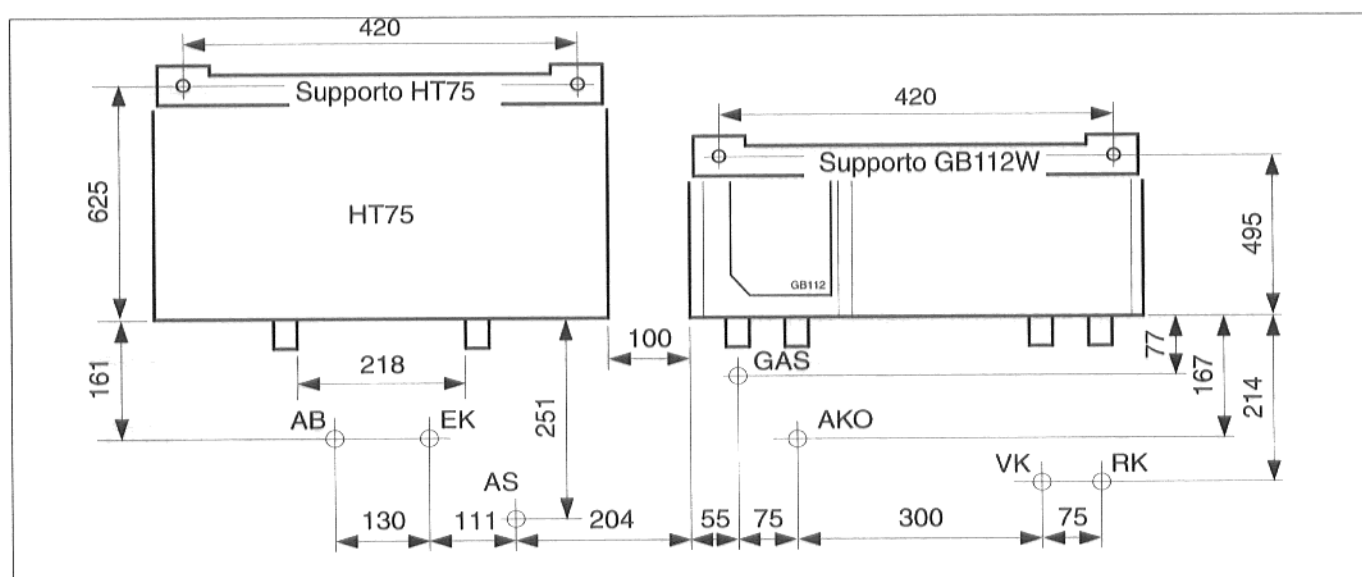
dimensioni di ingombro GB112-24/W oppure -29/W con HT75 a sinistra
